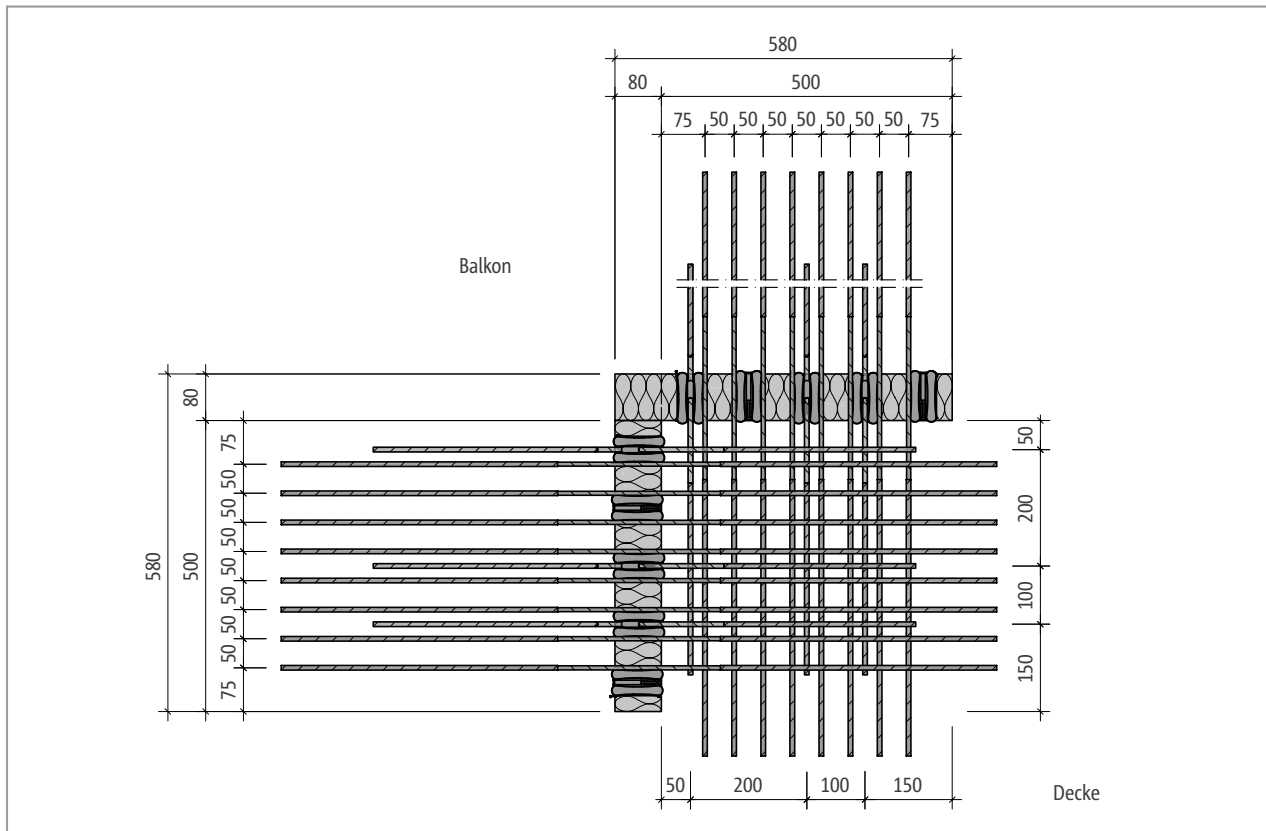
Schöck Isokorb® T Typ C-M1: Produktgrundriss
